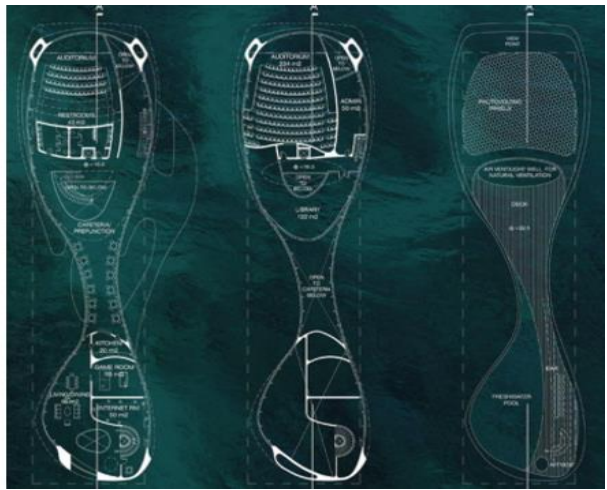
Plan 2 et 3ème niv+ terrasse; Source : Bali tangram 3D,2018
